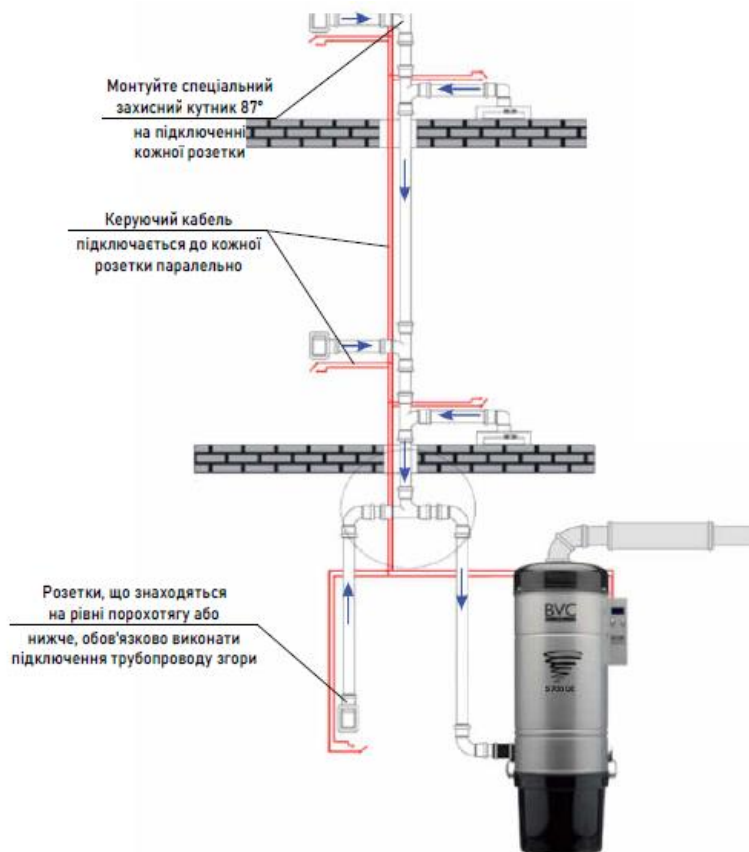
Схема монтажу кабелю керування та трубопроводів
